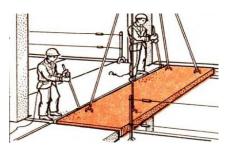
Наведение, ориентирование и установка плит перекрытия
